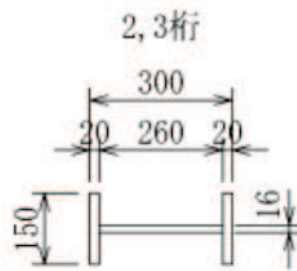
主桁（2, 3桁）の断面形状（単位：mm）
